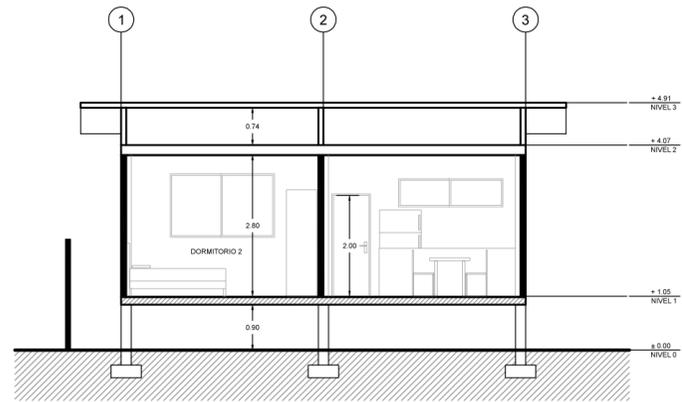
Plano Arquitectónico, configuración V2.
